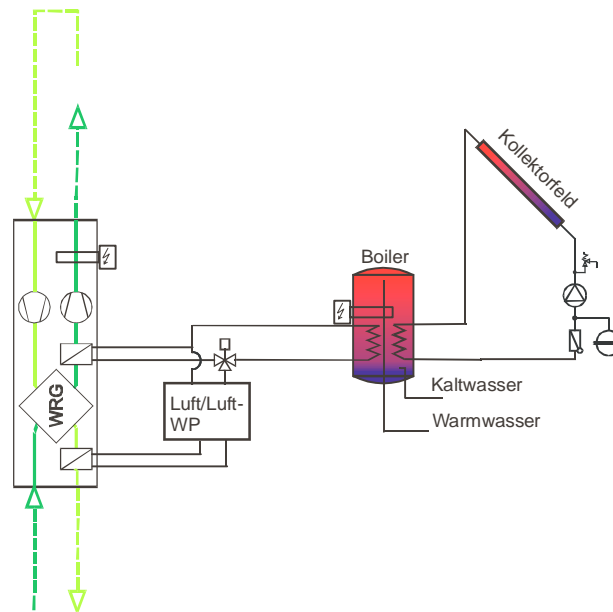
System 1 – Kleinstwärmepumpe mit Luftheizung – dezentral (Kollektorfeld und EWT empfohlen)
